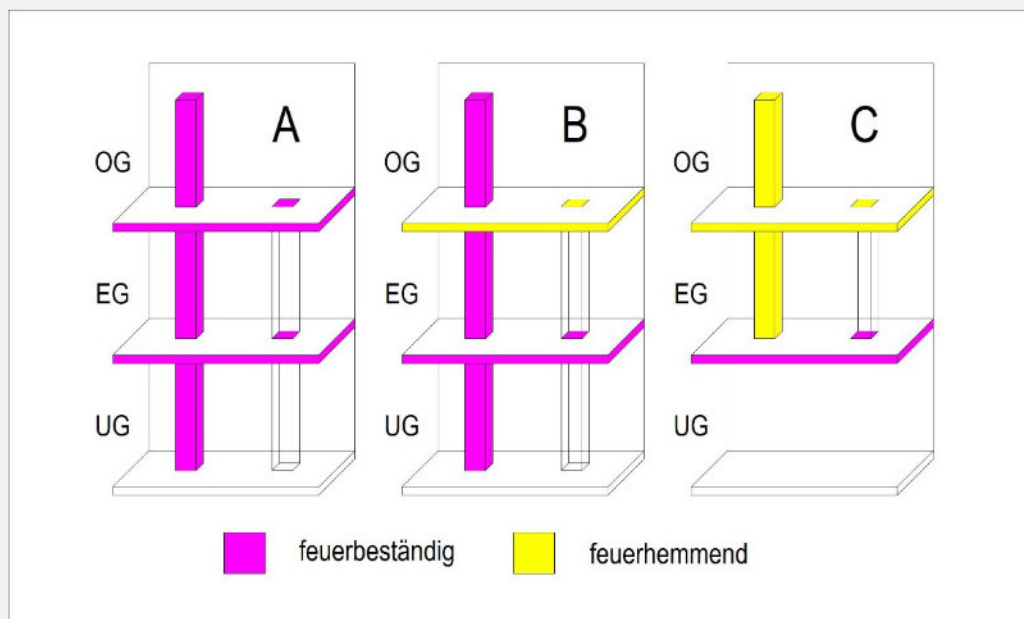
| Grundsystematik Installationsschächte/Geschosstrennung [Quelle: Sinfiro GmbH & Co. KG]
